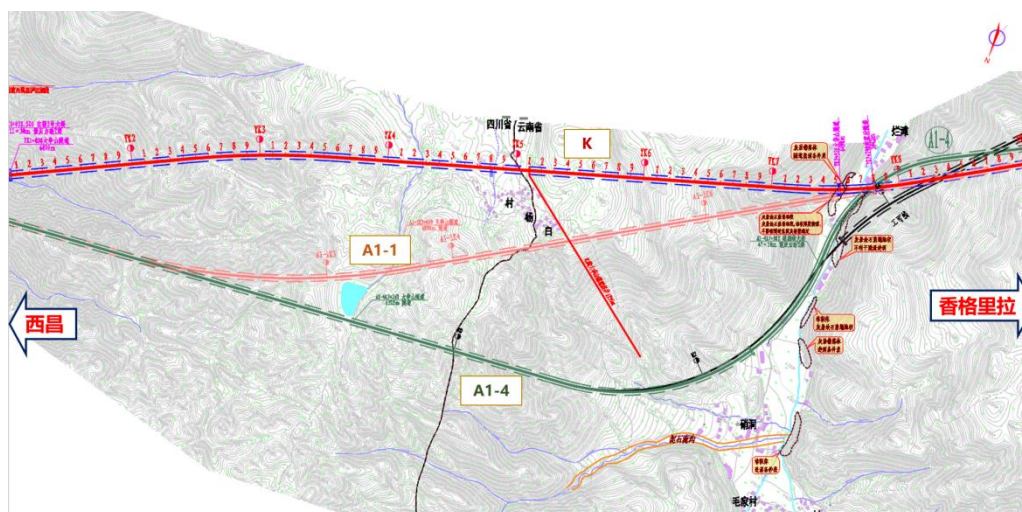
K、A1-1、A1-4 方案比较平面图
